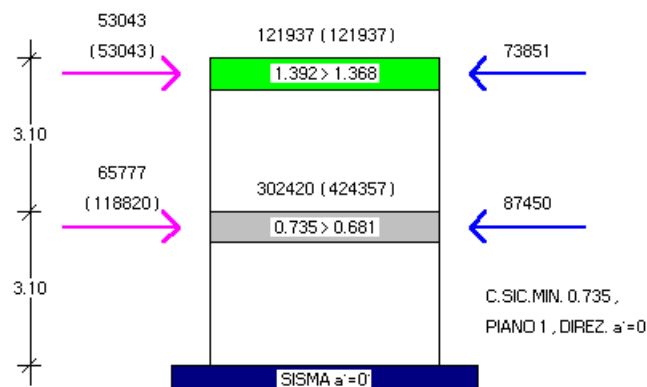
Schema Strutturale Pareti Piano Terreno.
